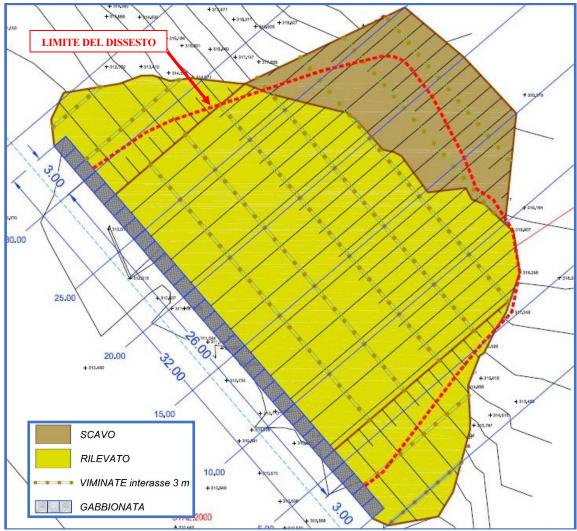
Zona intervento 2 – Planimetria dell'intervento
